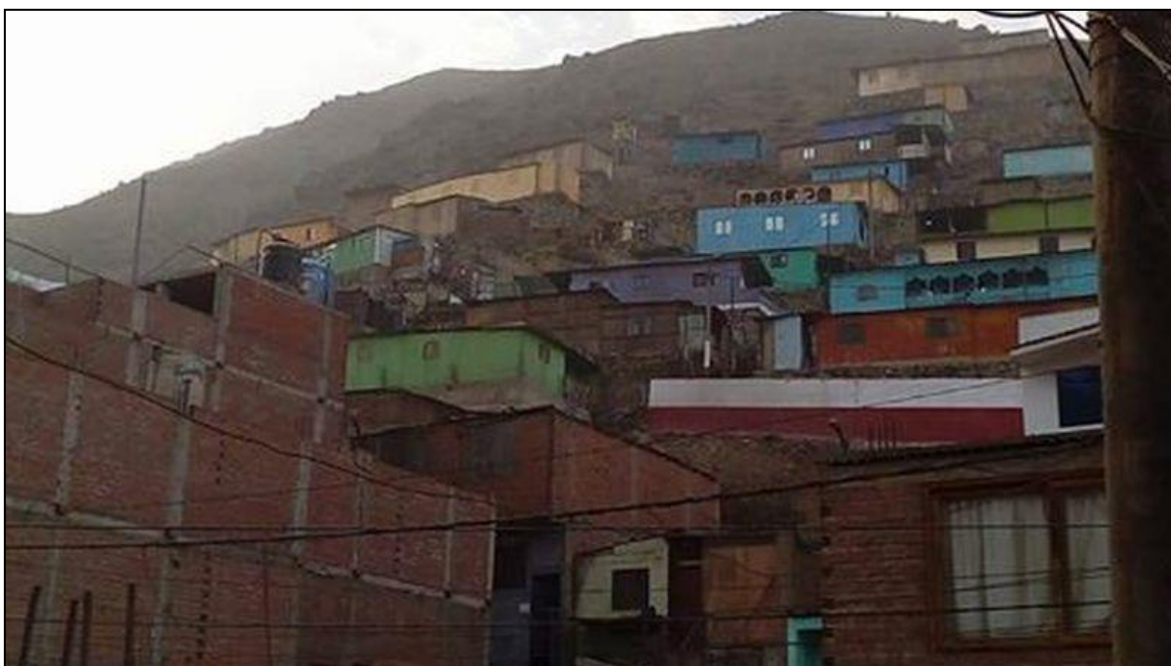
Áreas vulnerables en San Juan de Lurigancho
